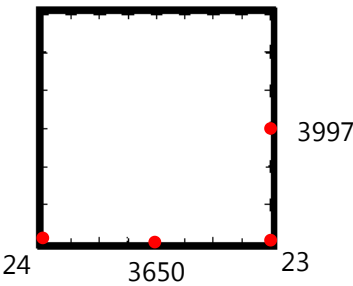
w Pila vista en planta, posición de nodos analizados (en rojo).
